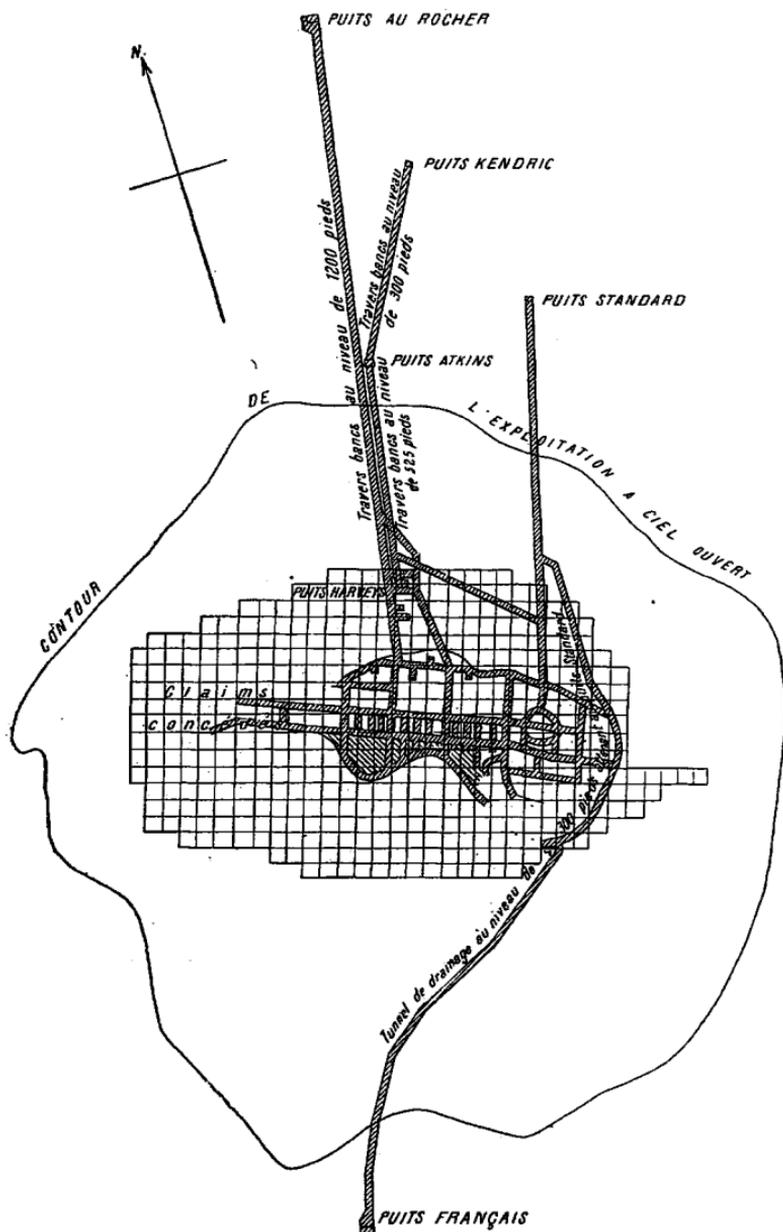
Plan de la mine de Kimberley au niveau de 1 200 pieds, 30 juin 1896.
